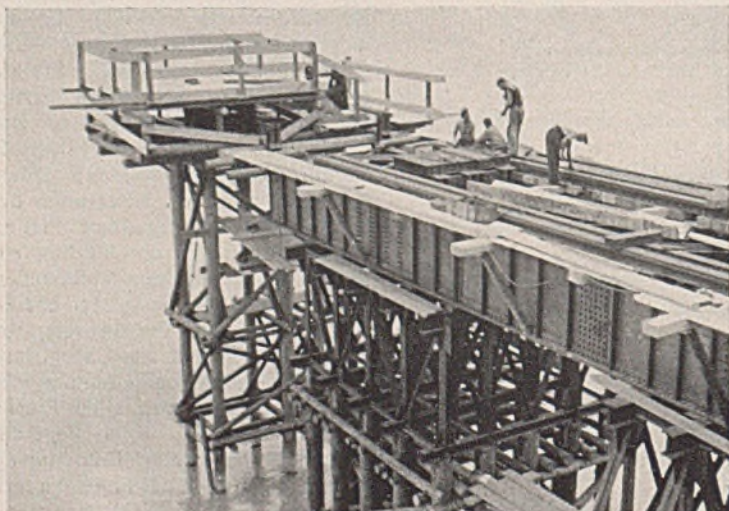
Fertiges Joch zur Auflagerung der ausgeschobenen Brücke mit den stählernen Aufsätzen zur Lastverteilung, den Verschubträgern und Schlenen. Links außen Windengerüst.
